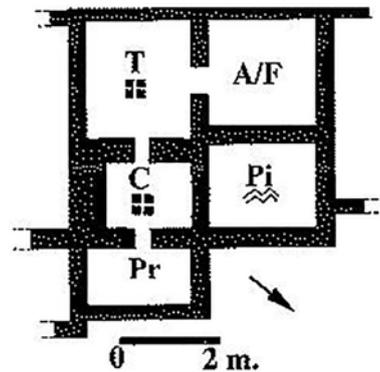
Planta de los baños de Pujol de Beniató, Castellón (GARCÍA, 2003).
